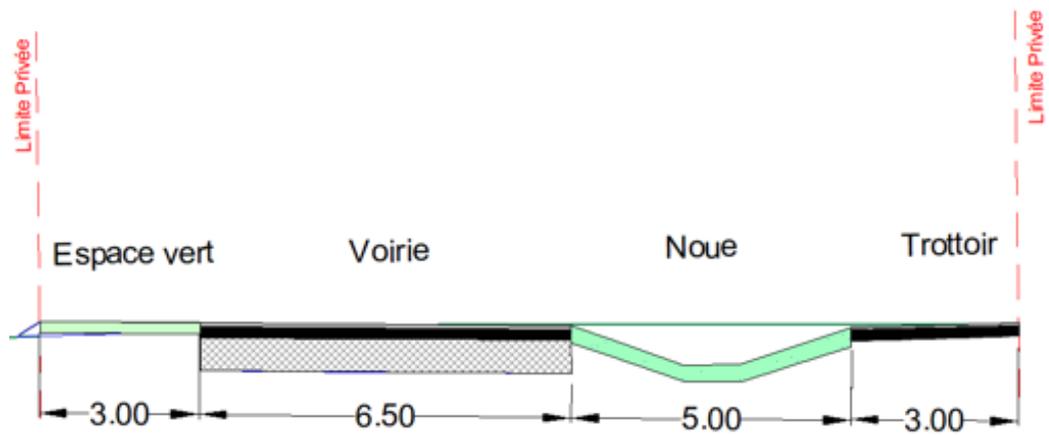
Plan de coupe des ouvrages d'infiltration
